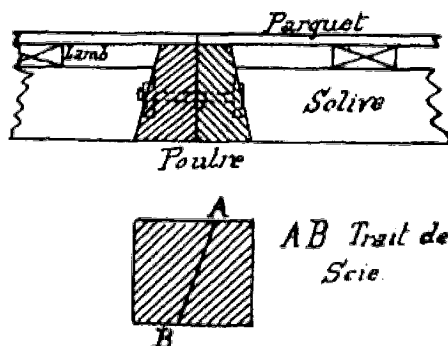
Disposition d'un plancher avec poutre noyée dans l'épaisseur des solives.
